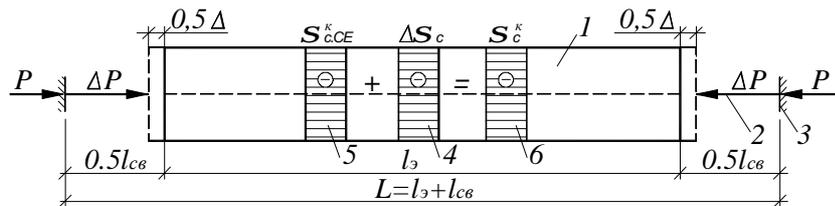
Схема действующих усилий при предварительном напряжении арматуры комбинированным способом: 1 – элемент из бетона на НЦ;
